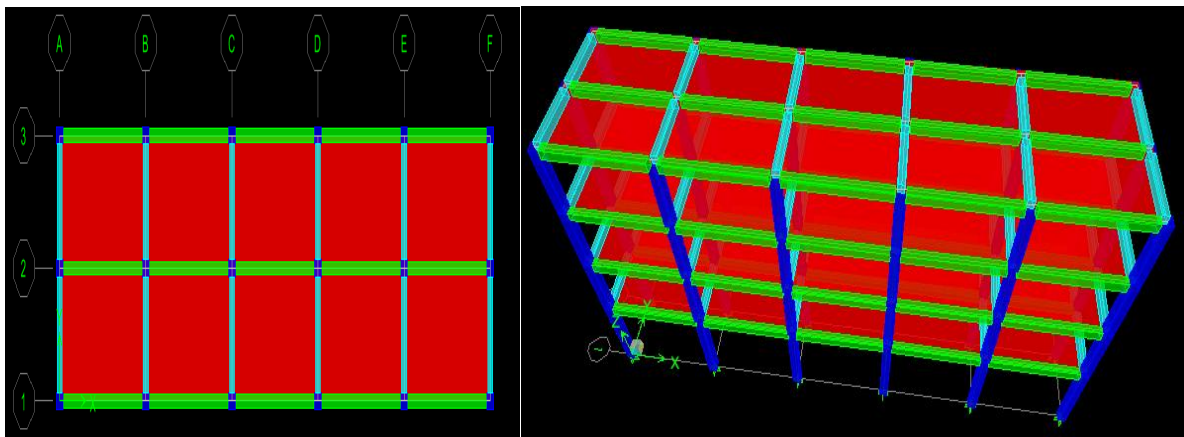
Géométrie en plan et en élévation de la structure élancée en plan.
